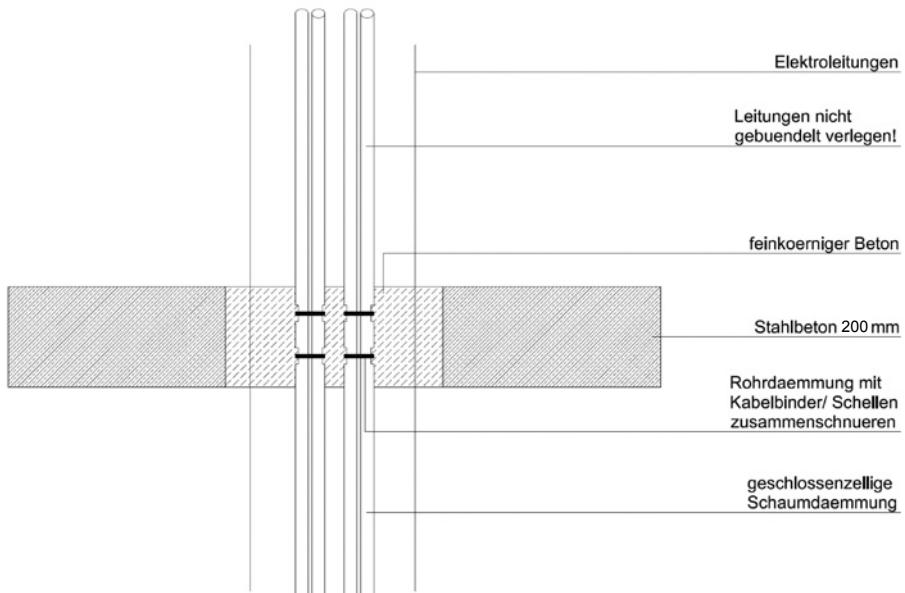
Vertikale beispielhafte luftdichte Rohrdurchführung durch eine Stahlbetondecke [Schöberl & Pöll GmbH]
